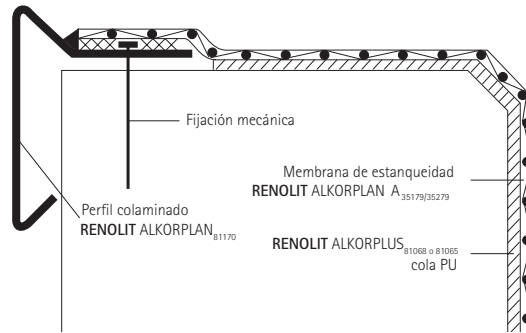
Encolado en la totalidad de la membrana RENOLIT ALKORPLAN A
